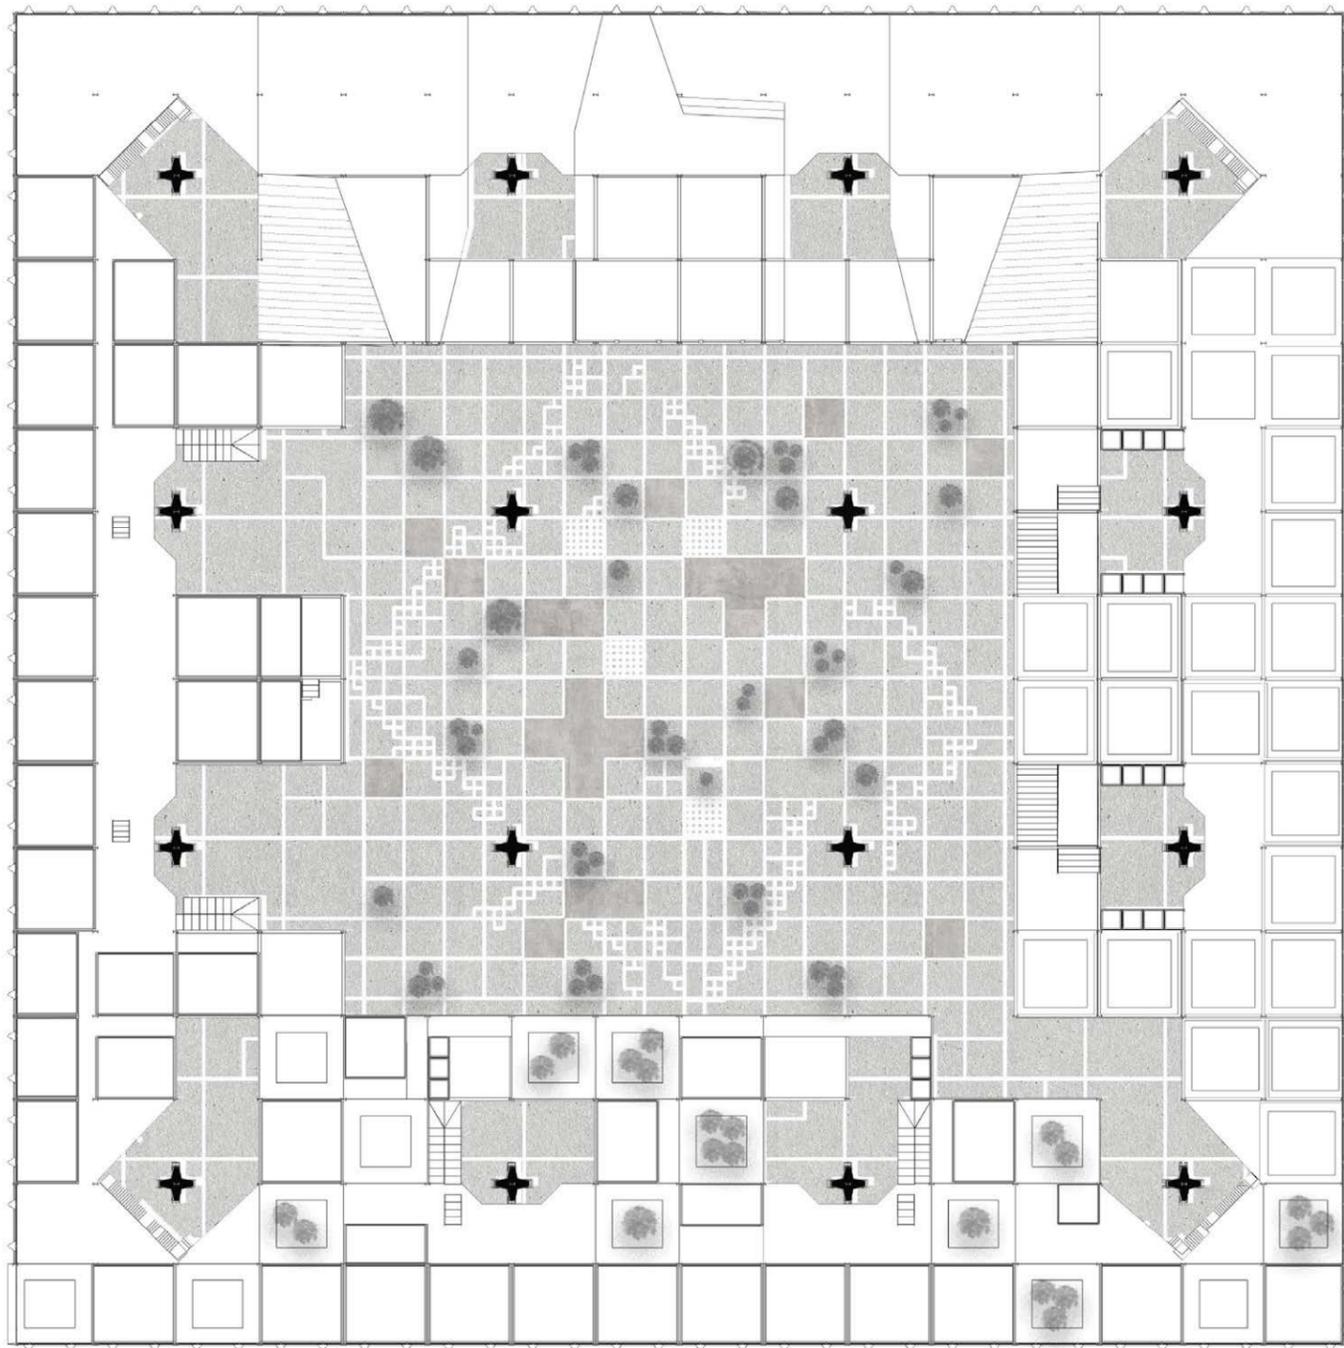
Pianta piano primo dell'intervento Regole e Città nel Palazzo. Elaborato degli autori. Scala 1: 1000
